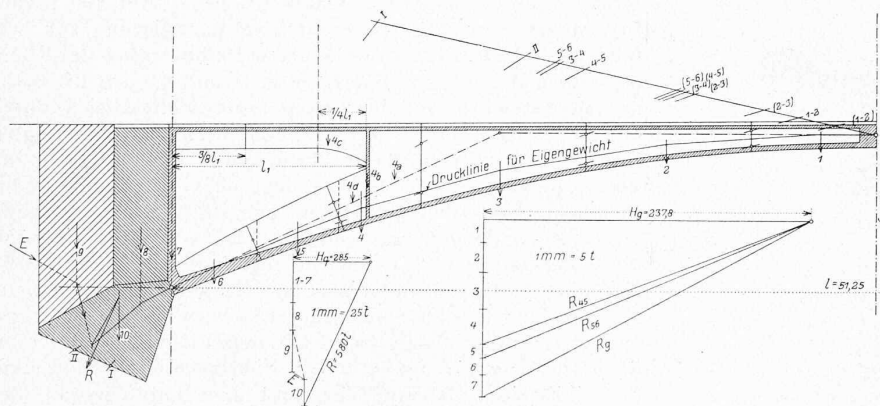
Längsschnitt 1 : 250 einer Brückenhälfte mit Kräfteplan.
